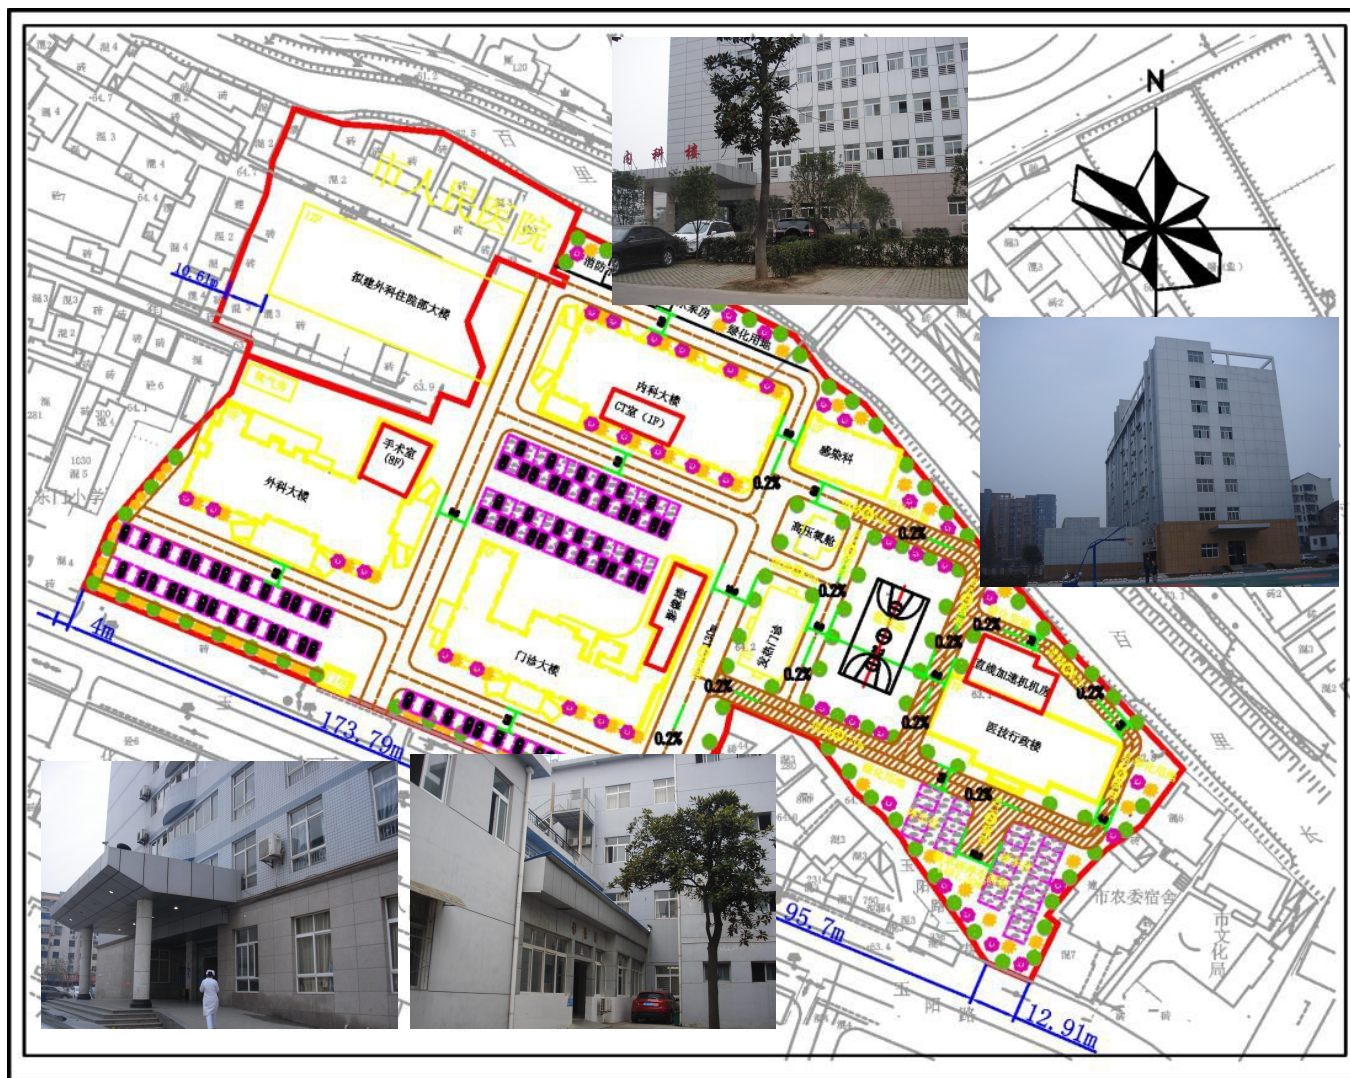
当阳市人民医院平面布置及周边环境状况示意图
